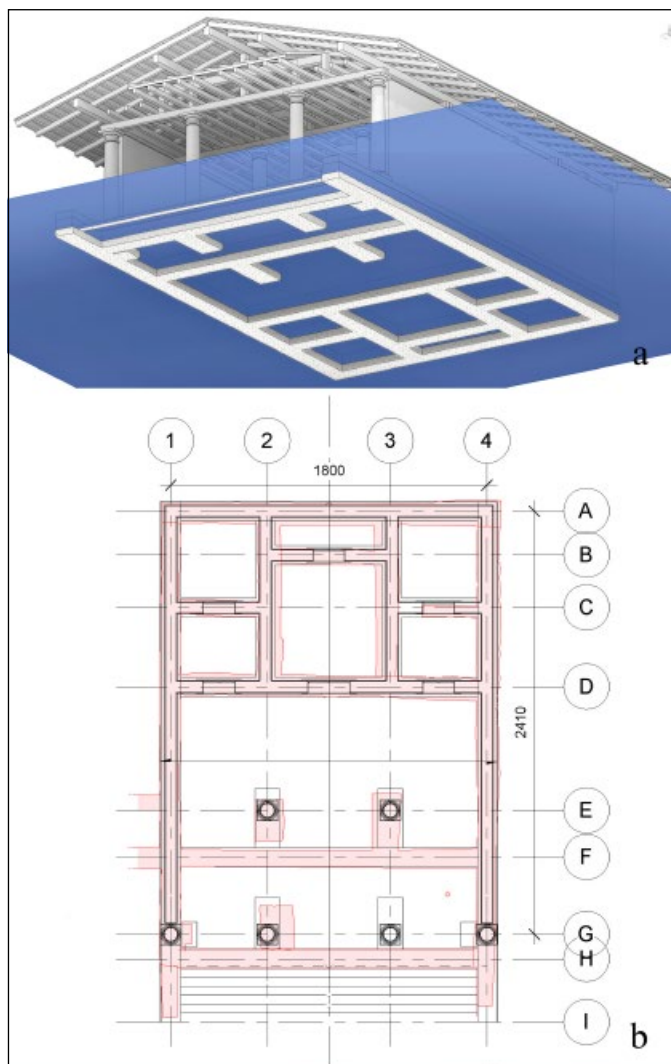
Disposizione planimetrica del modello BIM, con in evidenza la resa tridimensionale della struttura di fondazione (a) e il profilo delle fondazioni rinvenute (b).
